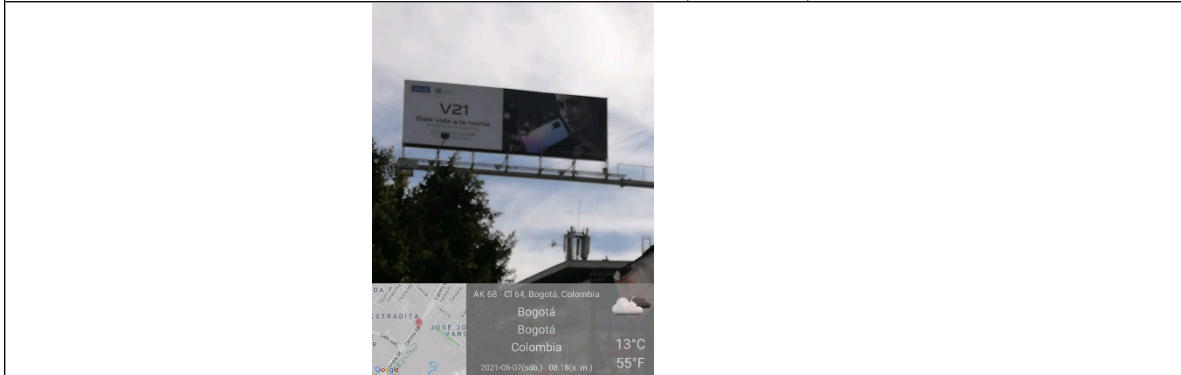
Vista del panel y de la estructura de la valla orientación (Sur-Norte).
